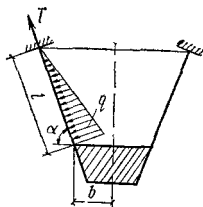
Расчетная схема стенки гибкого бункера с жесткими разгрузочными воронками. Воронка заштрихована
